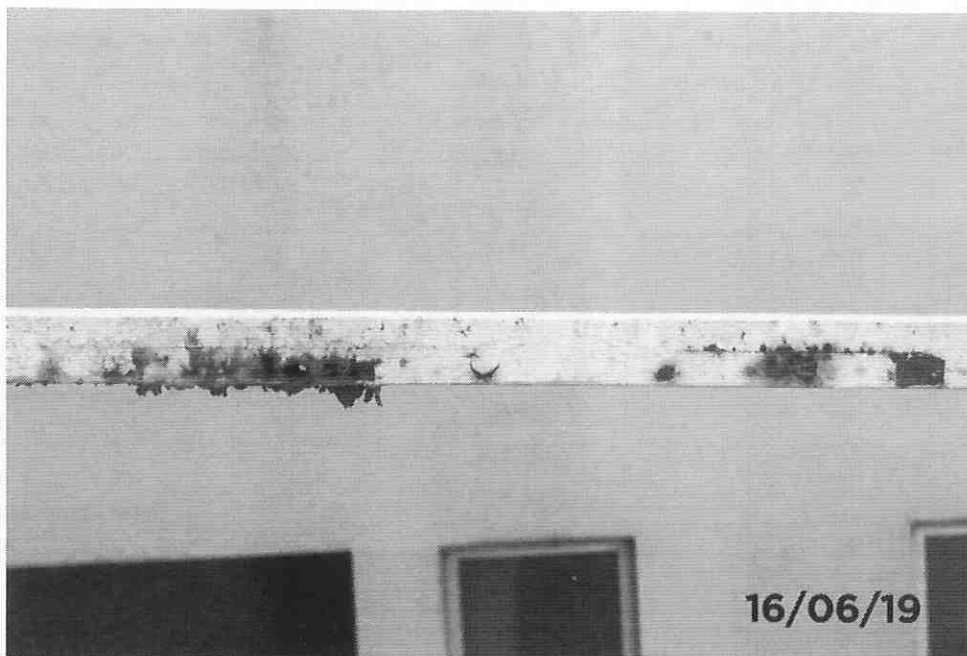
Detalhe pontos de corrosão na estrutura metálica no guarda corpo.
